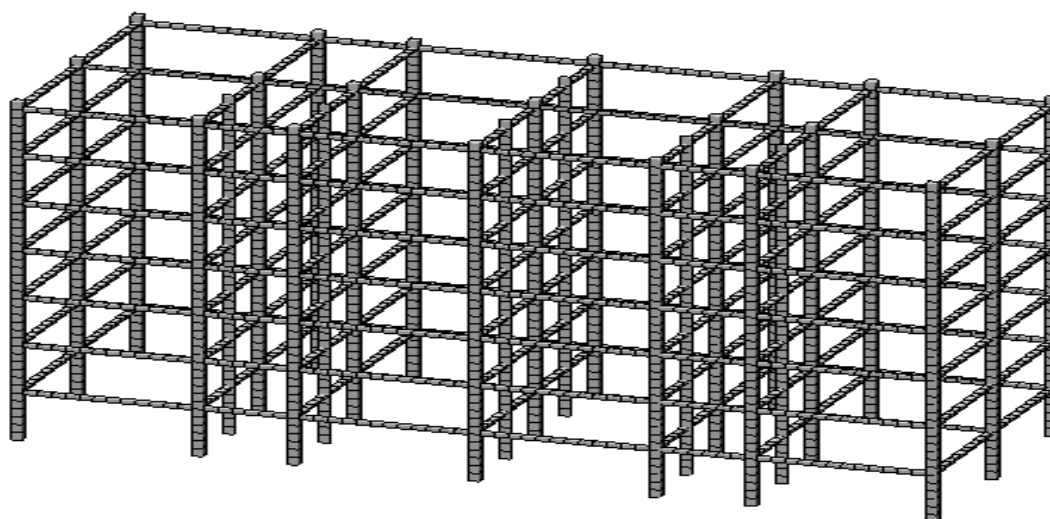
Схема расположения железобетонных вертикальных включений и сейсмопоясов
